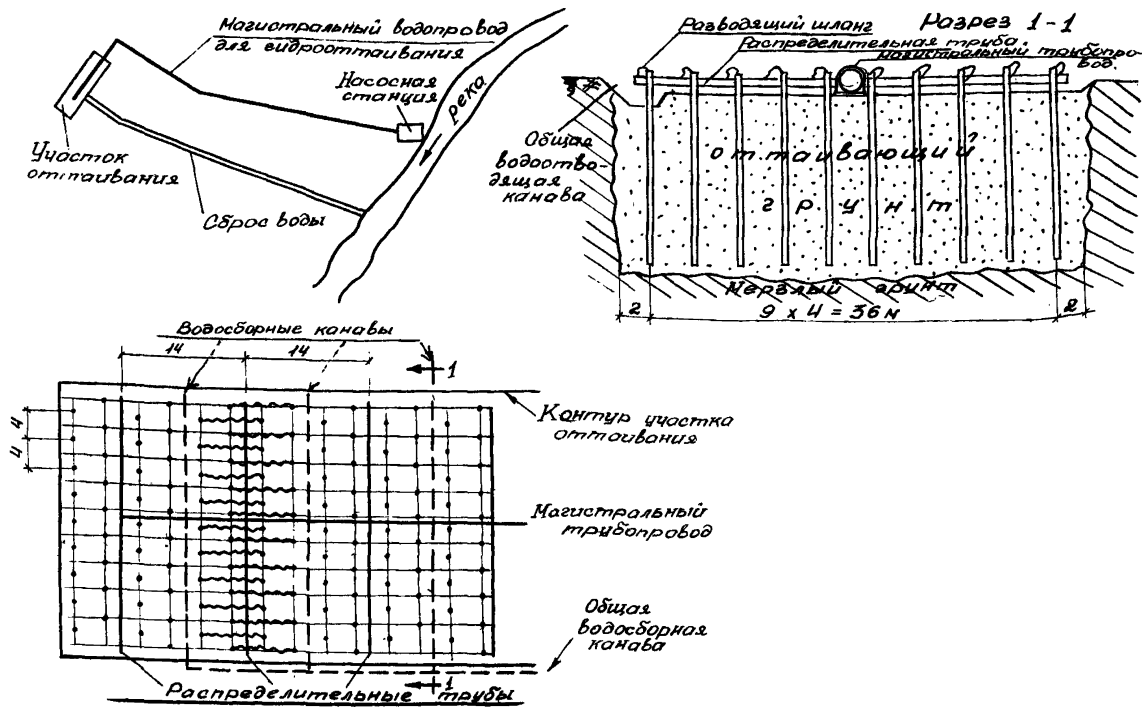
Схема гидрооттаивания крупнообломочных мерзлых грунтов.
